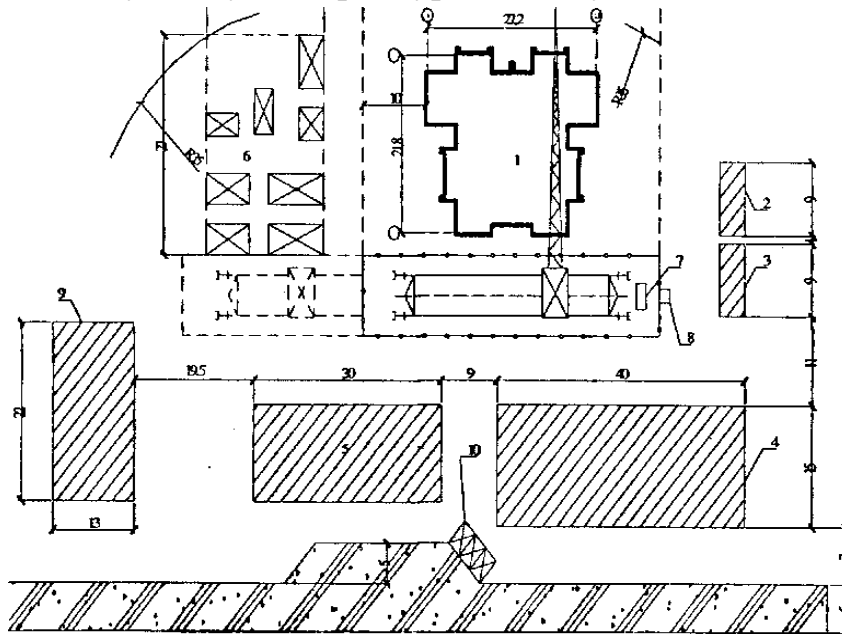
Будгенплан на зведення будівлі в блочно-щитовій опалубці:
